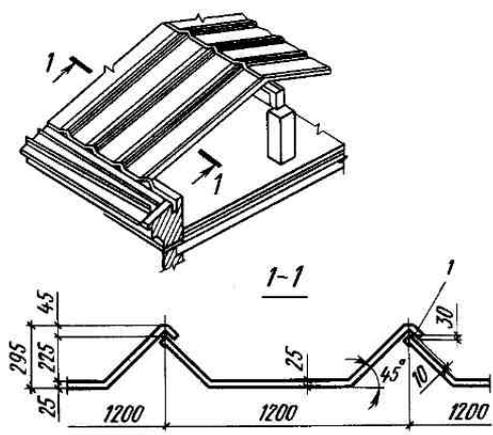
Сборная железобетонная скатная крыша из складчатых панелей трапецидального профиля:
